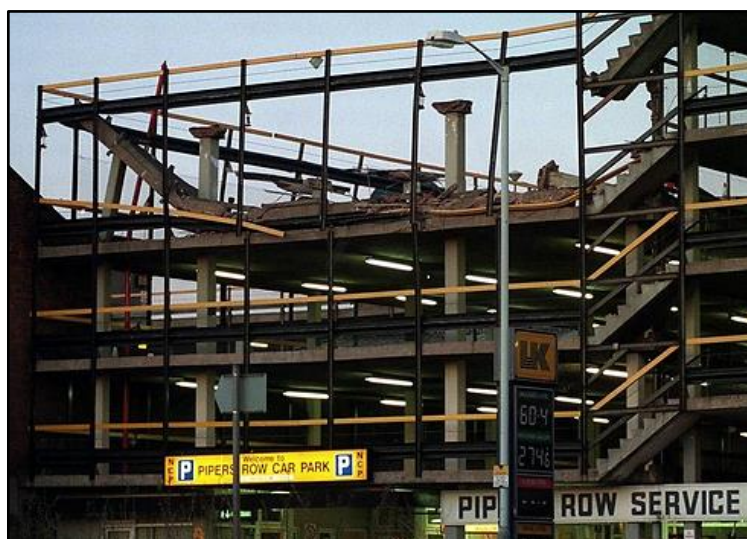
Colapso do último pavimento do *Pipers Row Car Park* (RHODES, 2022).
